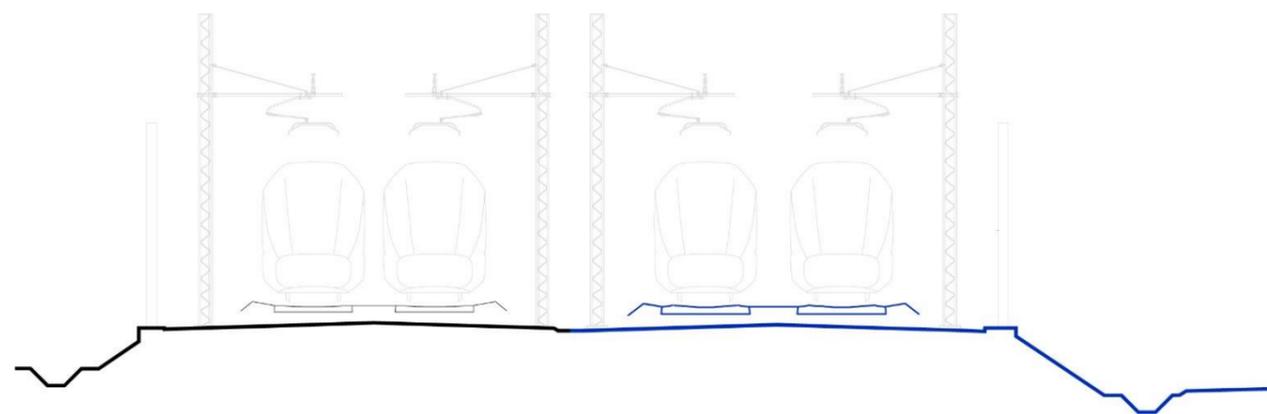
Progetto di quadruplicamento in affiancamento stretto (in blu) alla linea storica
